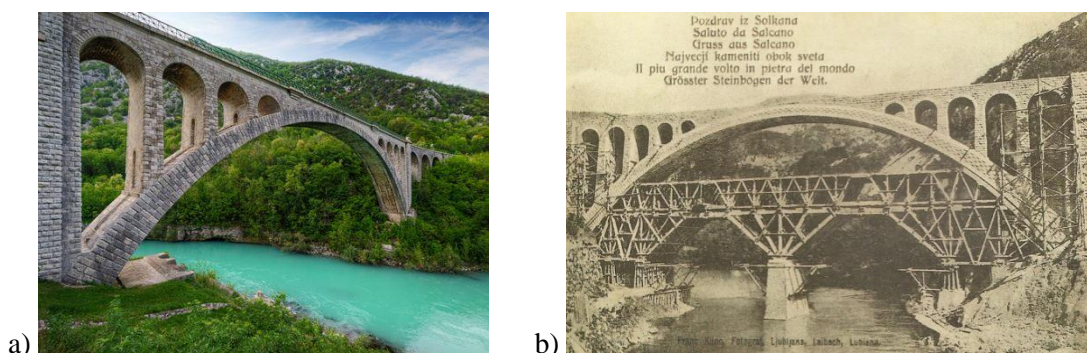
Ponte ferroviária Solkan, Eslovénia: a) na atualidade; b) construção e estrutura cimbra (www.alamy.com).
